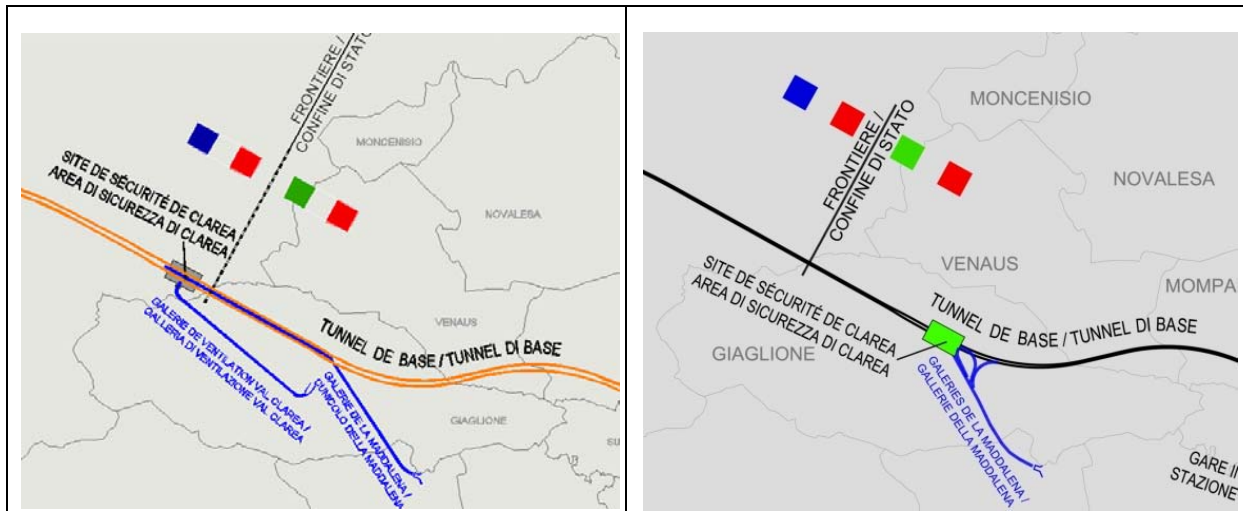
Confronto tra Key Plan di progetto definitivo approvato (sinistra) e variante (destra)
